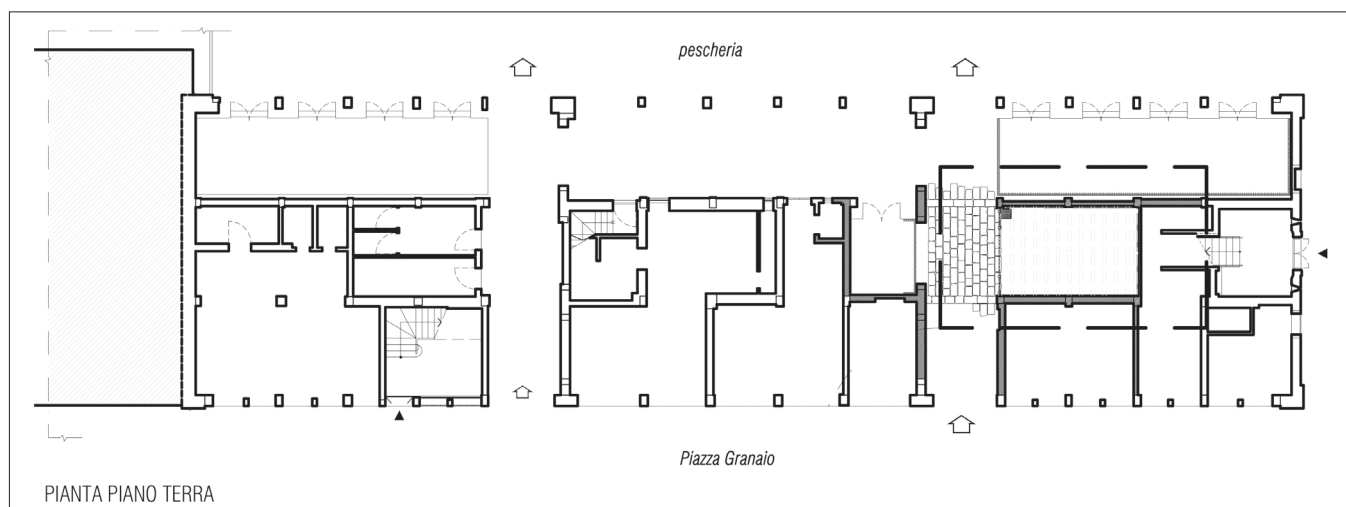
Palazzo Granaio, Rilievo del piano terra, 2021 – planimetria con evidenziata la Chiesetta della Madonnina (arch. Alberta Baldin)
